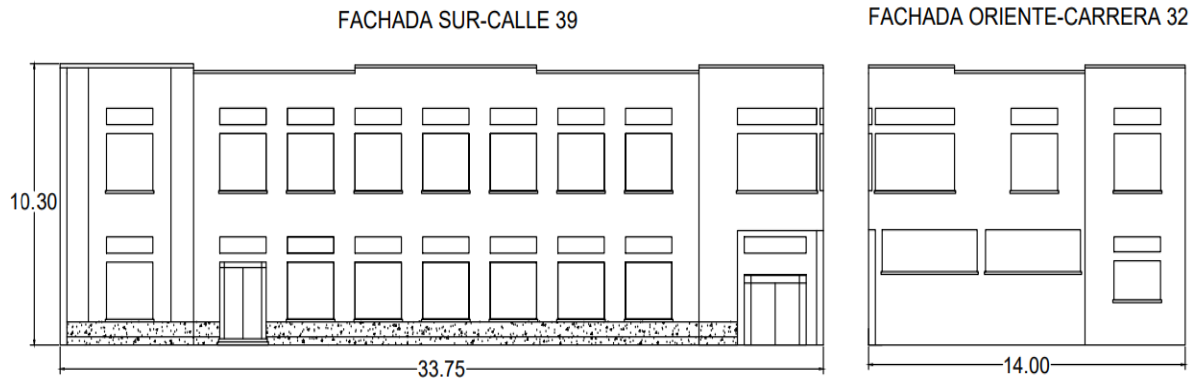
Edificio Nacional Fachada Sur y Oriente.
